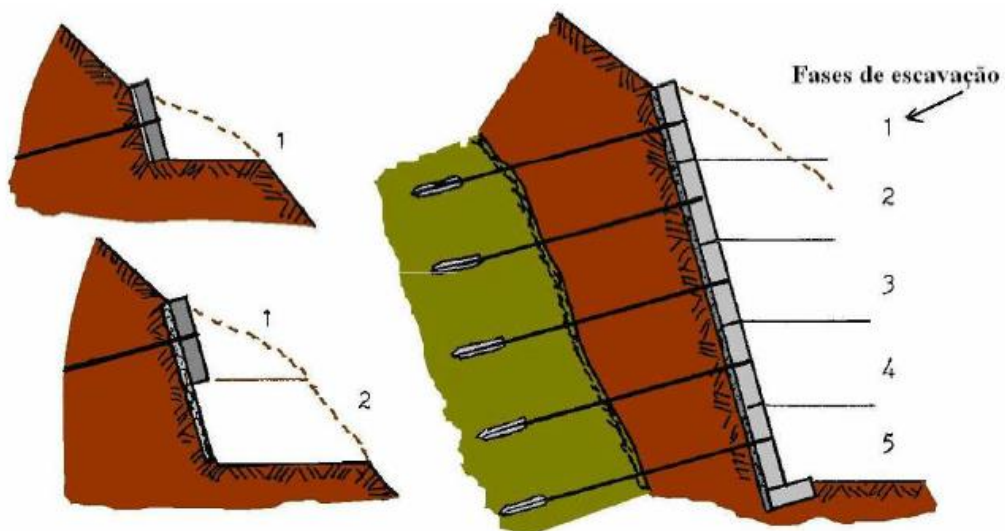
Muro ancorado, com faixas horizontais construídas faseadamente de cima para baixo [9].
